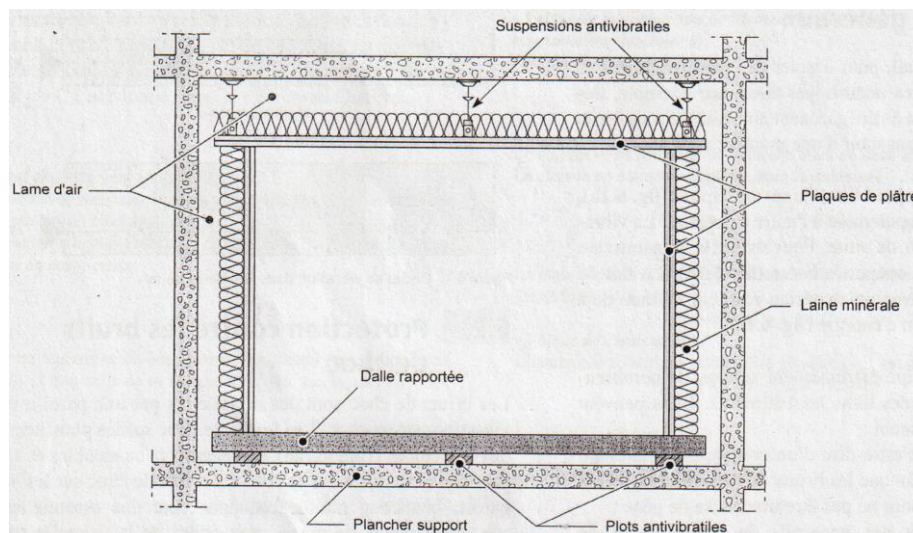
Le système « boîte dans la boîte » (Hamayon, 2008)
